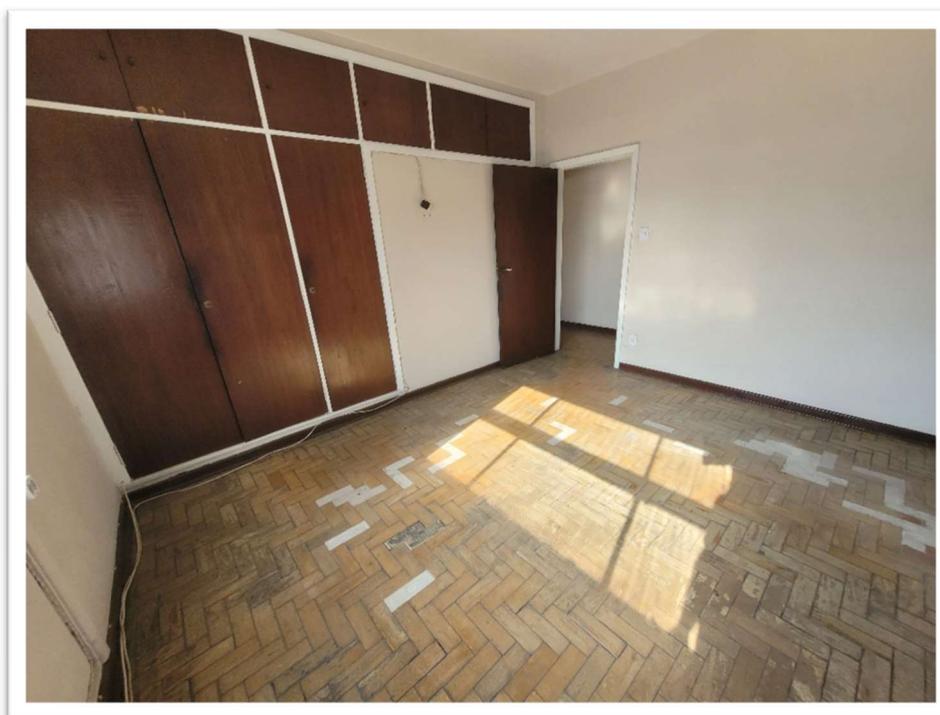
DORMITÓRIO – IMÓVEL PARADIGMA
